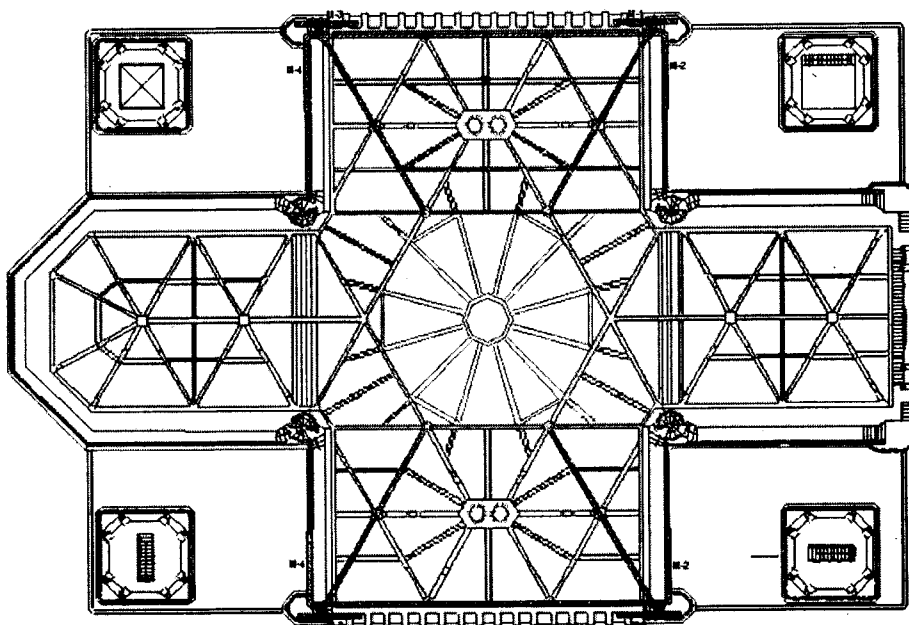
Planta de intervenciones de muros y vigas a nivel de cubierta
